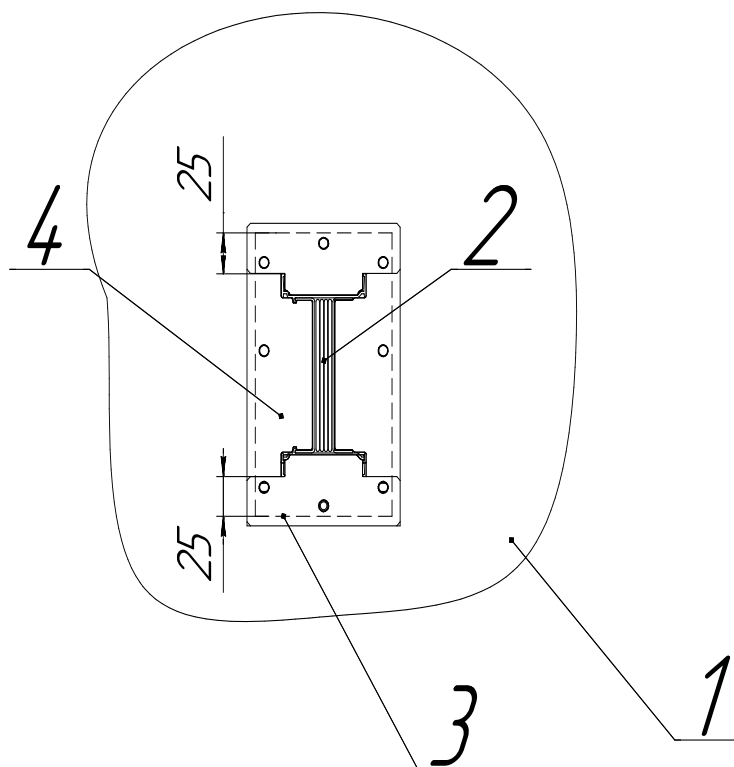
Схема выполнения проходки шинпровода через стену: 1 – стена или другое вертикальное перекрытие; 2 – шинпровод; 3 – отверстие в стене; 4 – декоративные пластины для закрытия зазора между шинпроводом и стеной.
